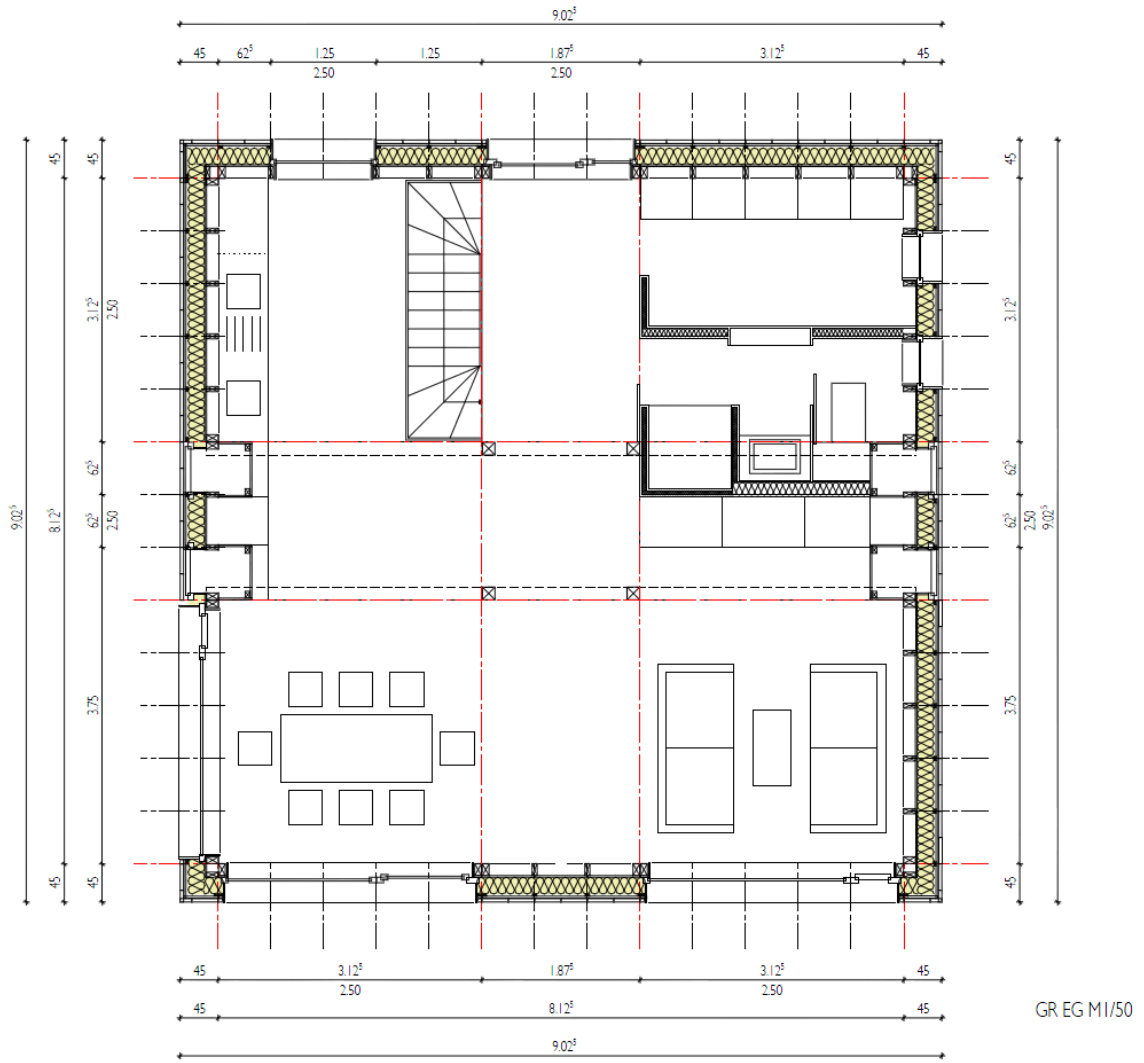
alternativer Aussenwandaufbau in der Grundrissdarstellung EG
